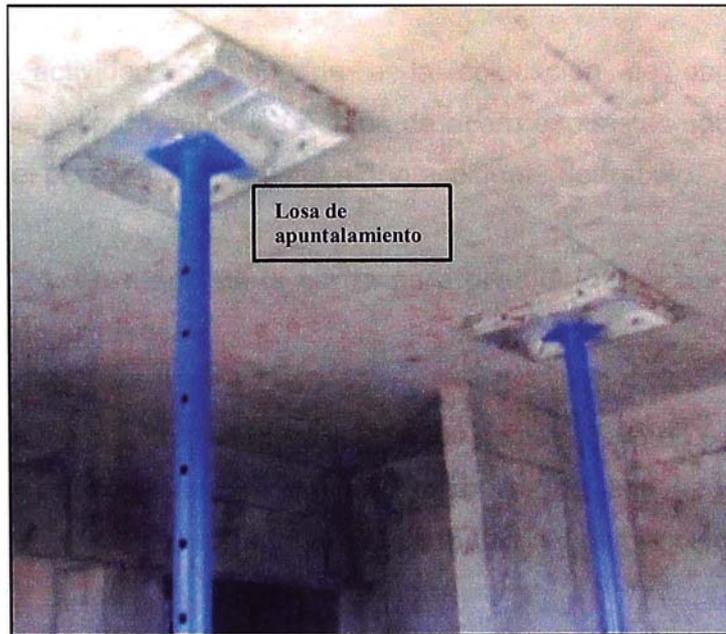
Encofrado metálico FORSA – vista encuentro muro y losa.
